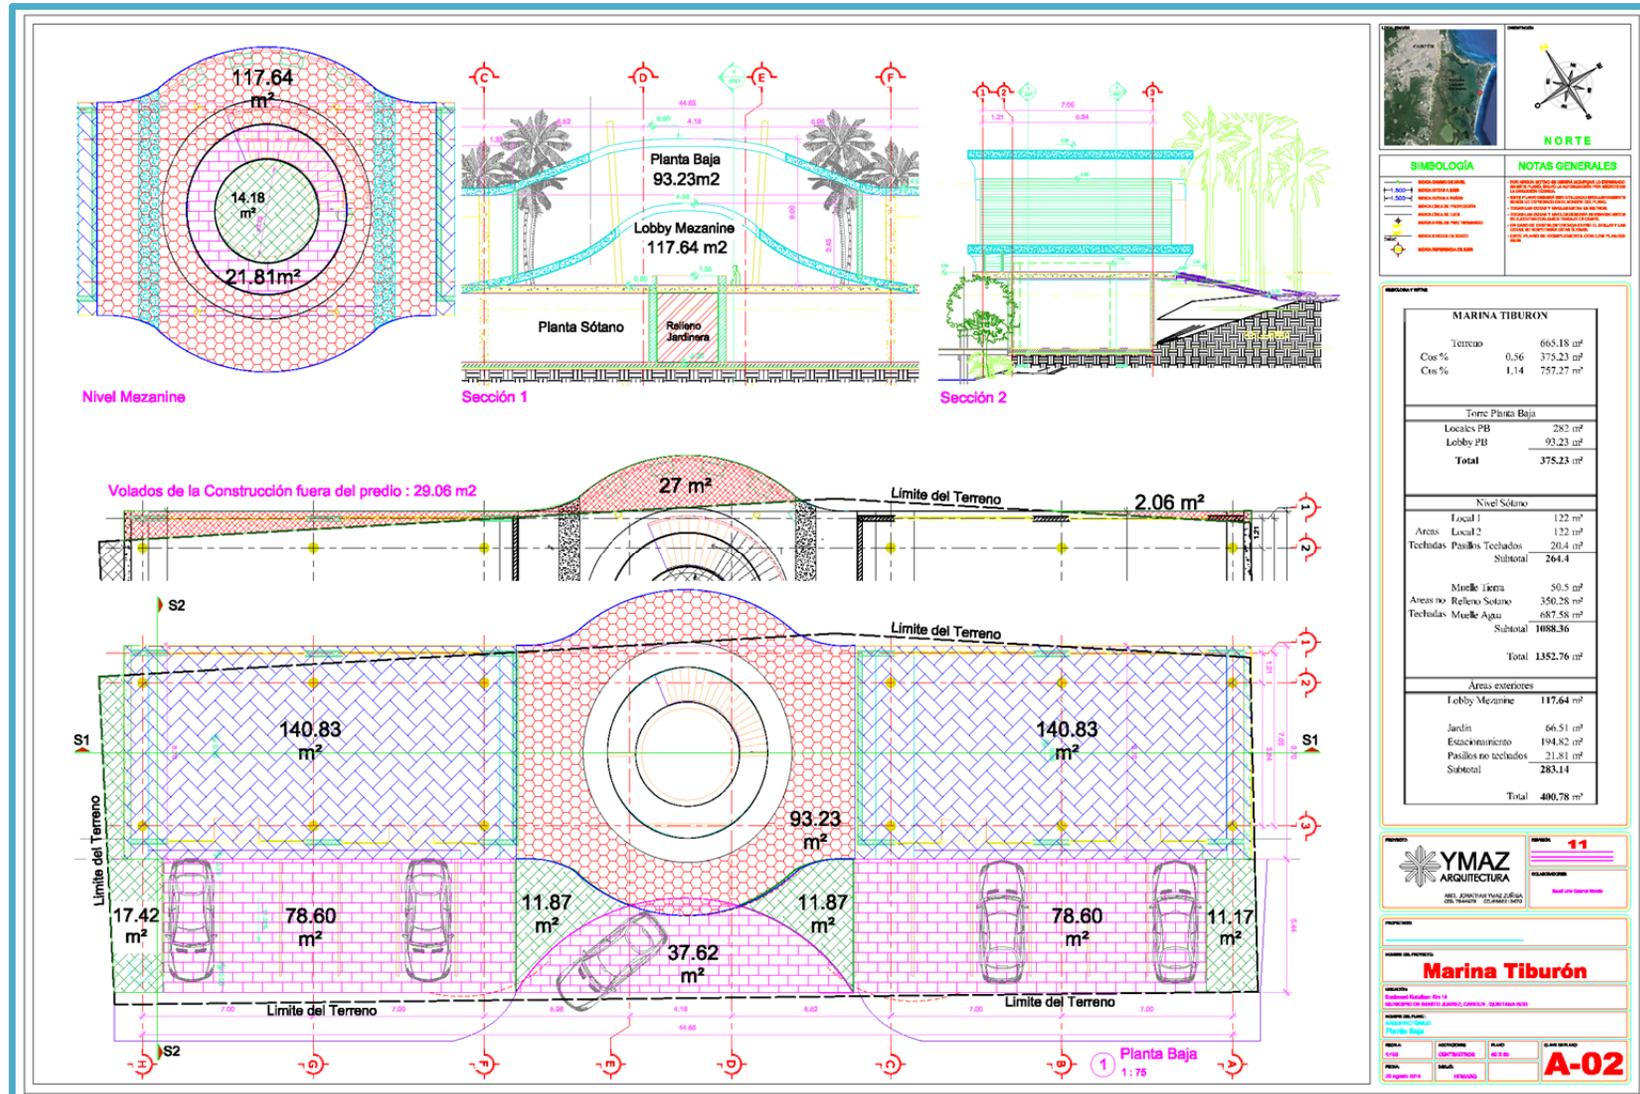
Plano arquitectónico planta baja. Fuente: Imaz Arquitectura/2014.
